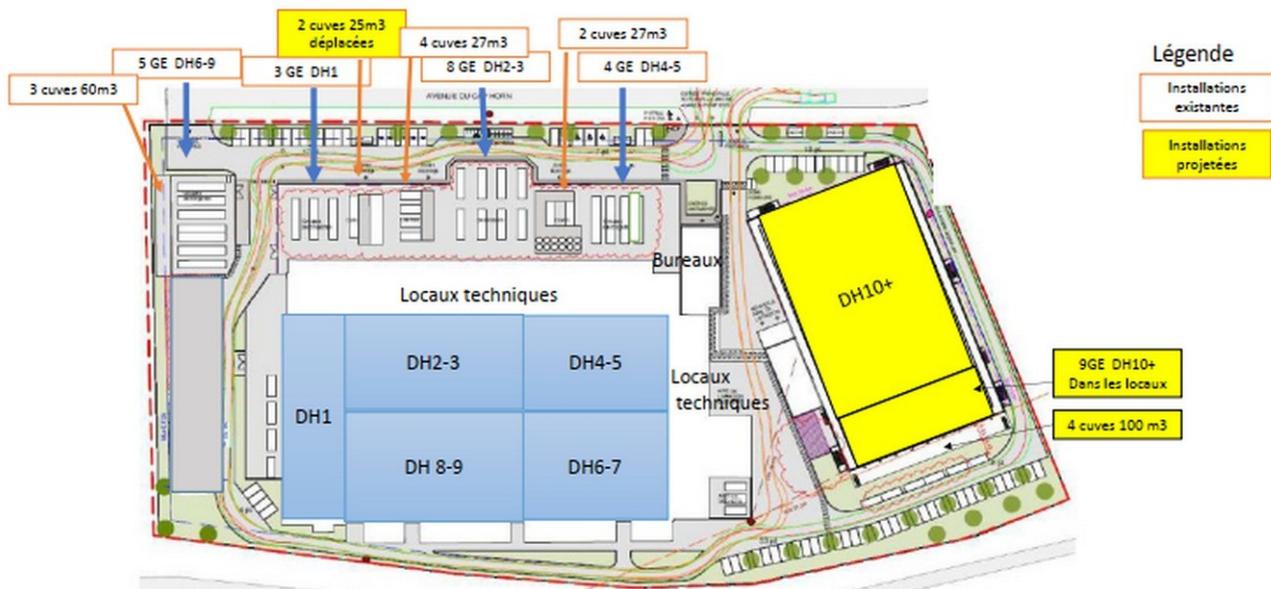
Plan du site et du projet (en jaune) - source : PJ n°46, p.6
